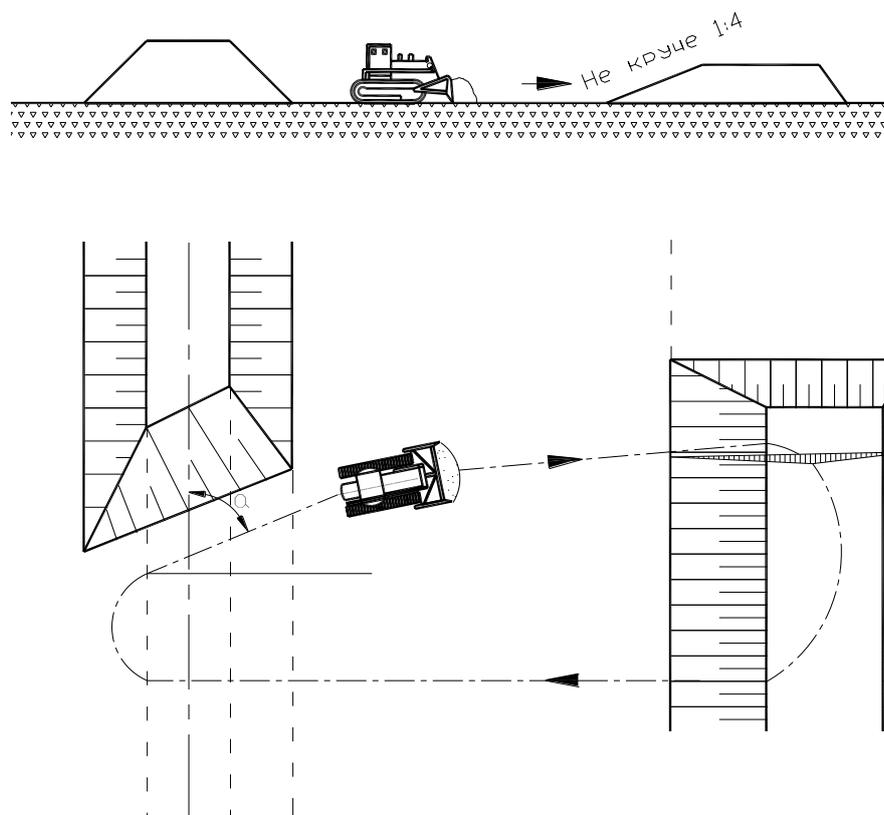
Схема перемещения бульдозером ранее разработанного грунта одноковшовым экскаватором
